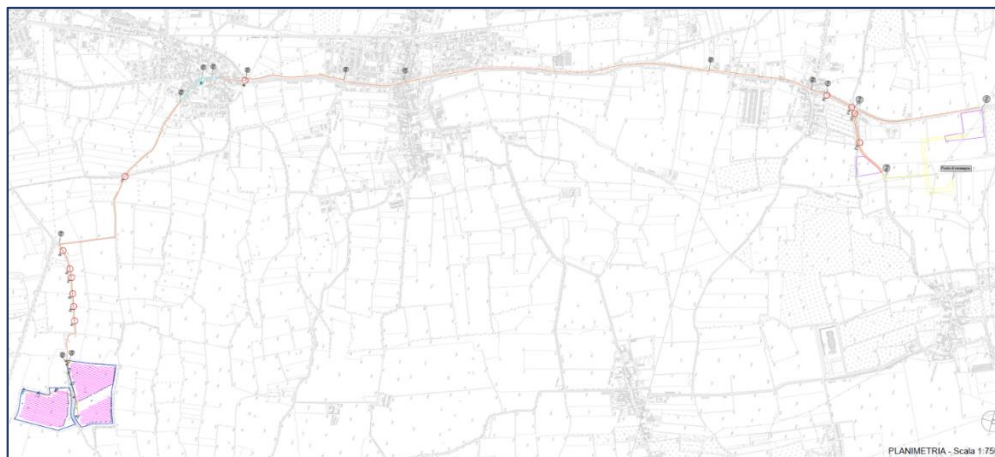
Planimetria generale linea di collegamento cavidotto con interferenze – Trivignano Sud – ST
